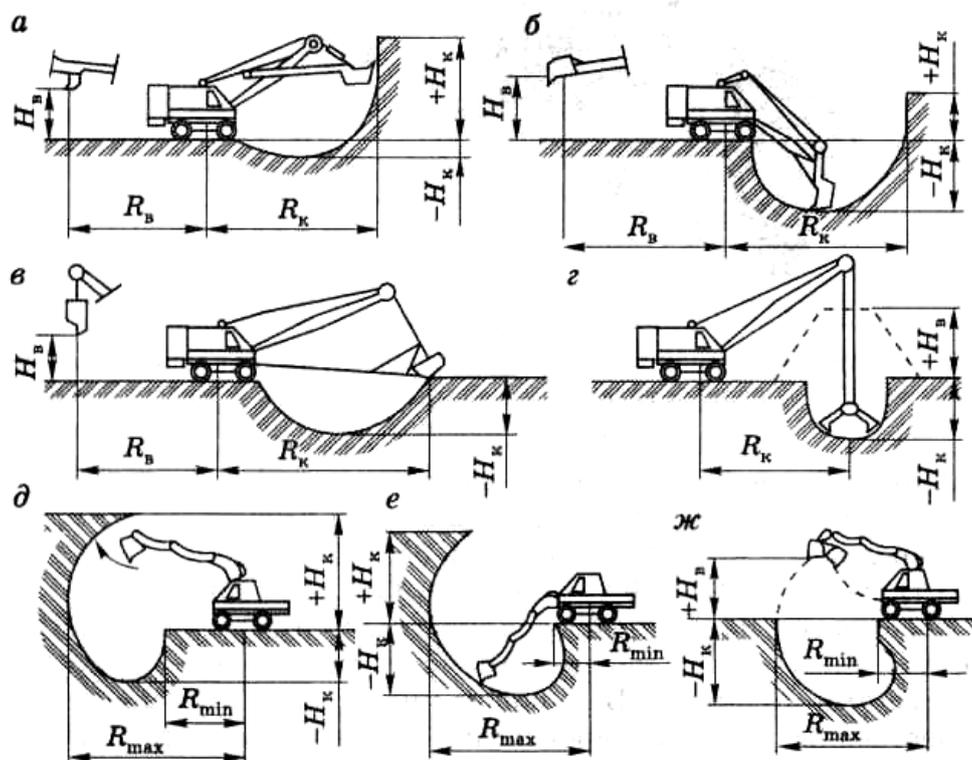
Профили забоев экскаваторов с различным рабочим органом: а - экскаватор прямая лопата с канатным приводом рабочего органа; б - экскаватор
